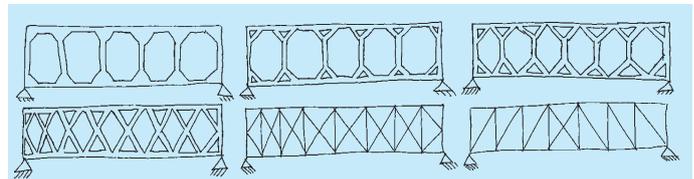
Развитие от фермы Веренделя до фермы крестовой решеткой
